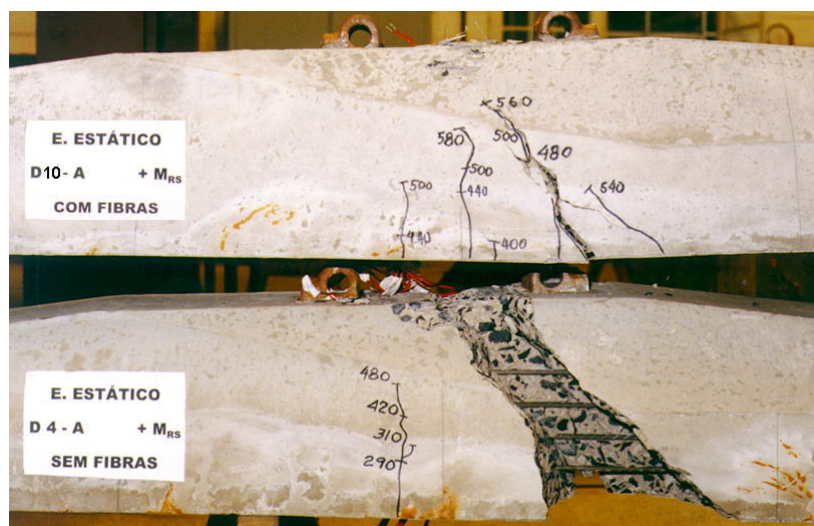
Configuração das fissuras após a ruptura dos dormentes originais D4 e D10.
